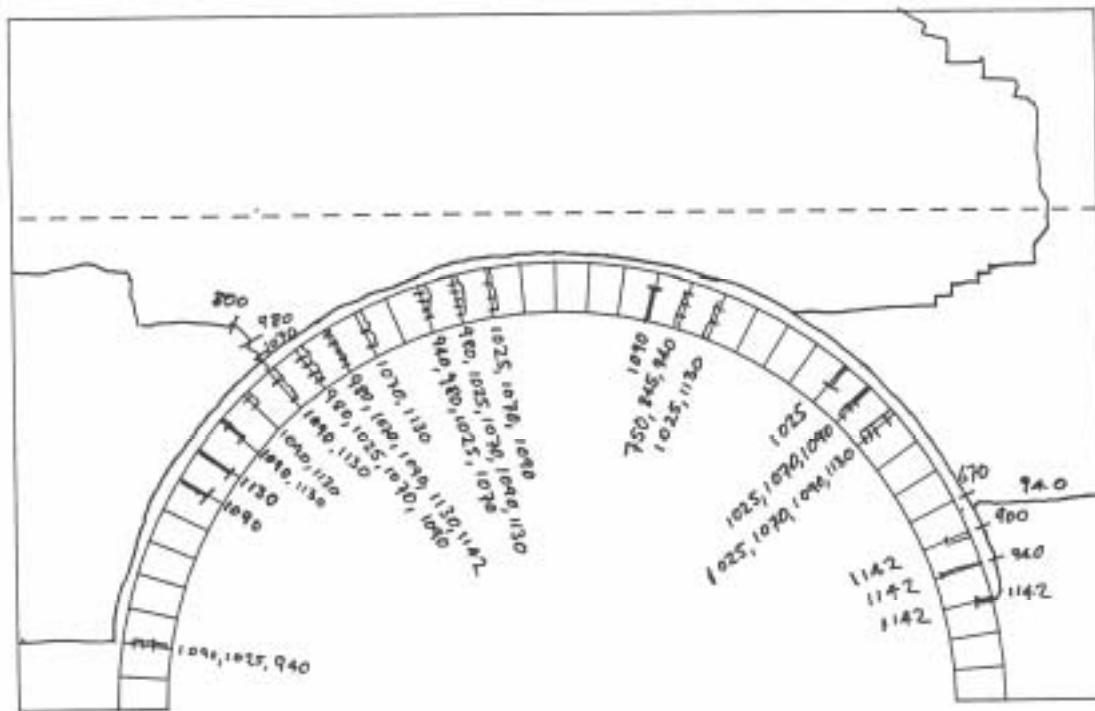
Localización y orden de aparición de las fisuras en el tímpano Este. Puente ensayado en la Universidad de Dundee [15].
